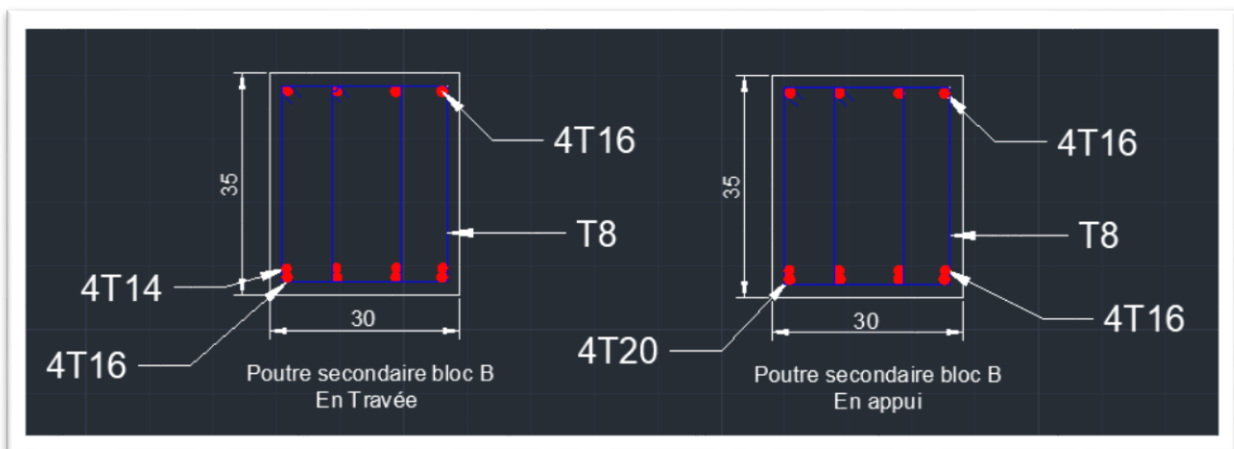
Schéma du ferrailage de la poutre secondaire du bloc B
